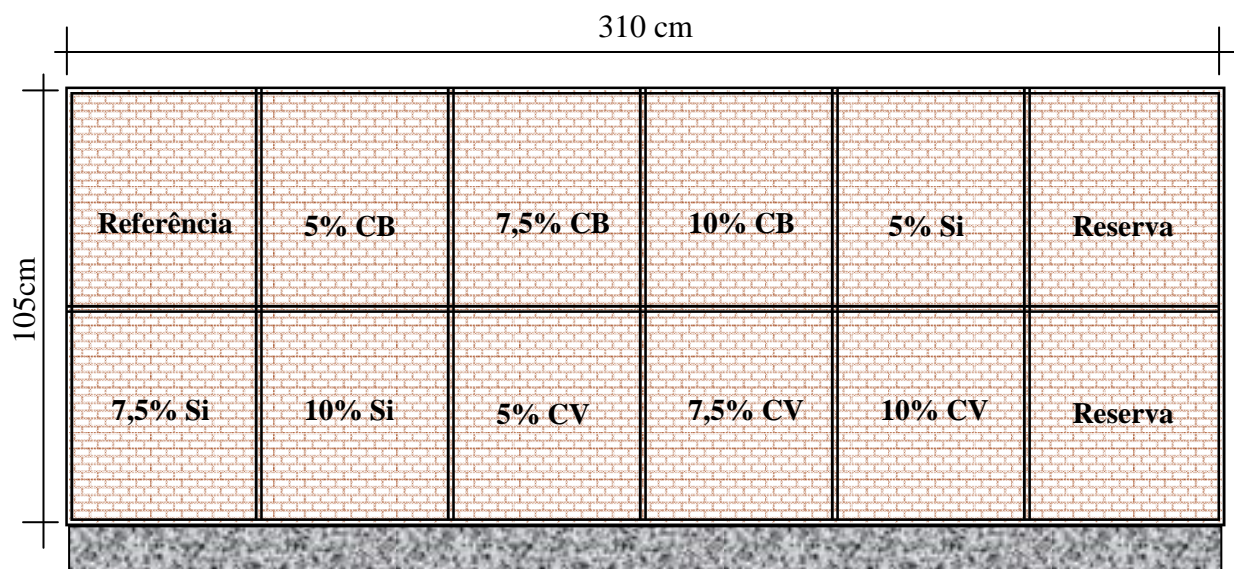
Arranjo de teste de arrancamento de argamassas
